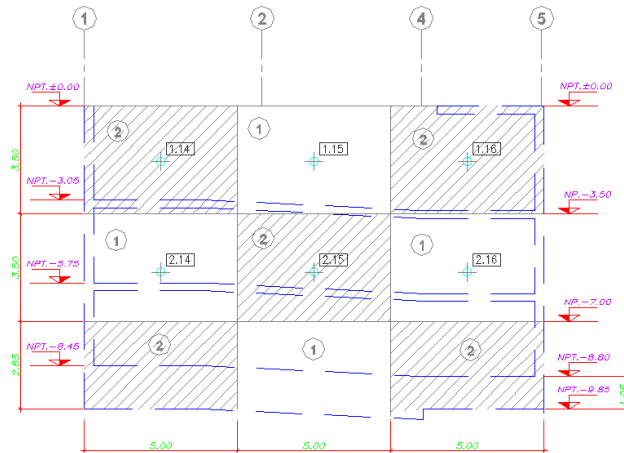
Muro Anclado - Detalle de Modulación en “Eje A”.
